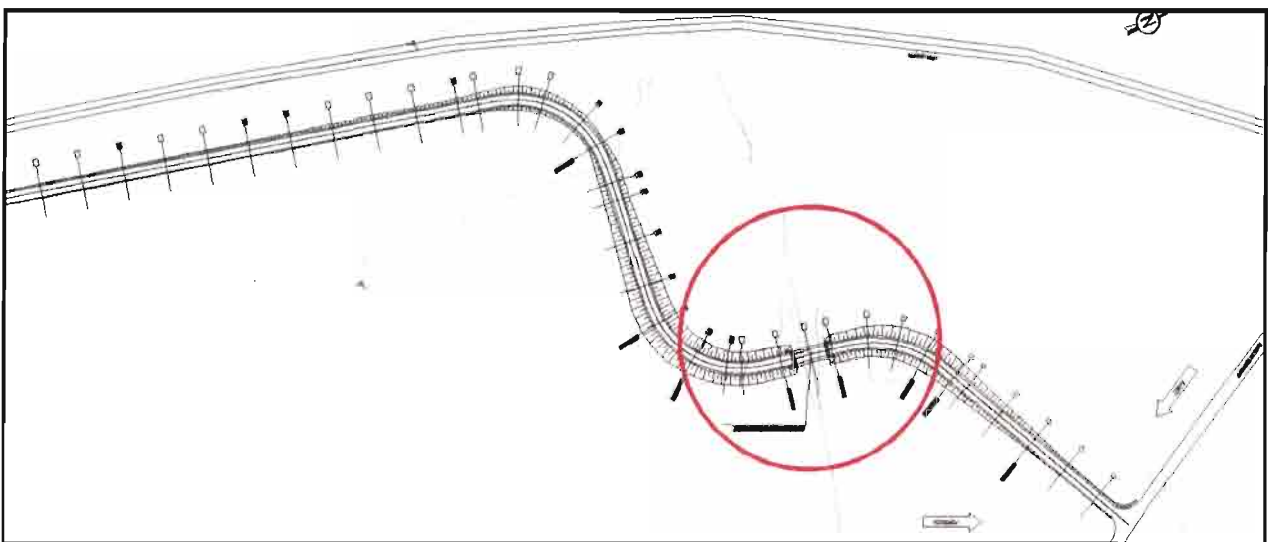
Brücke Afers Bach (Auszug aus dem Lageplan)
